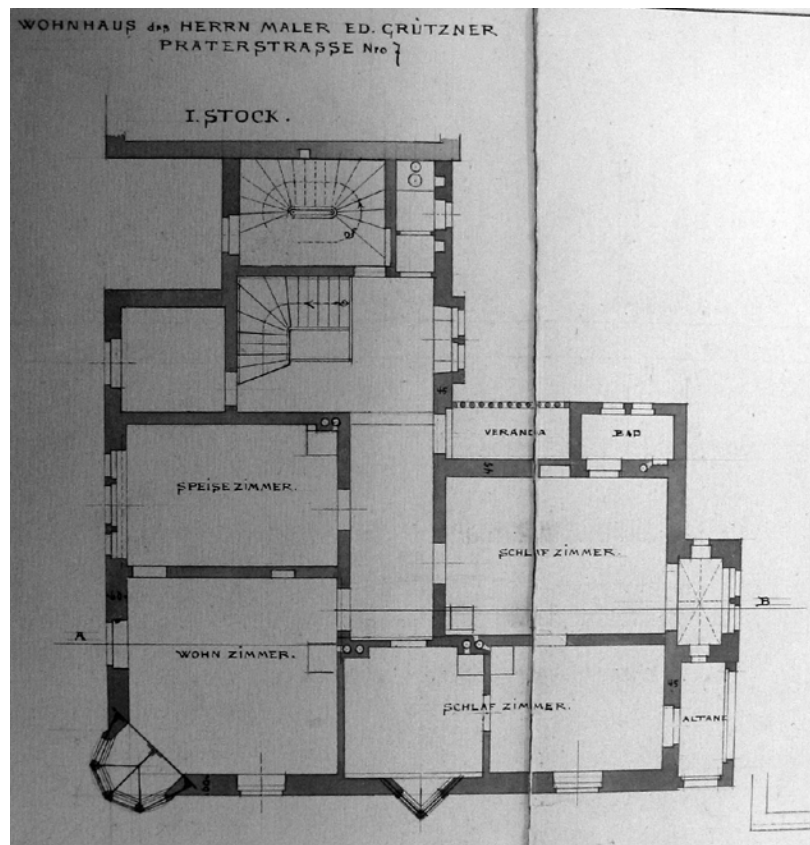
Grützner-Haus, Grundriß erster Stock, Leonhard Romeis, 1882, Plan nach Osten ausgerichtet.
